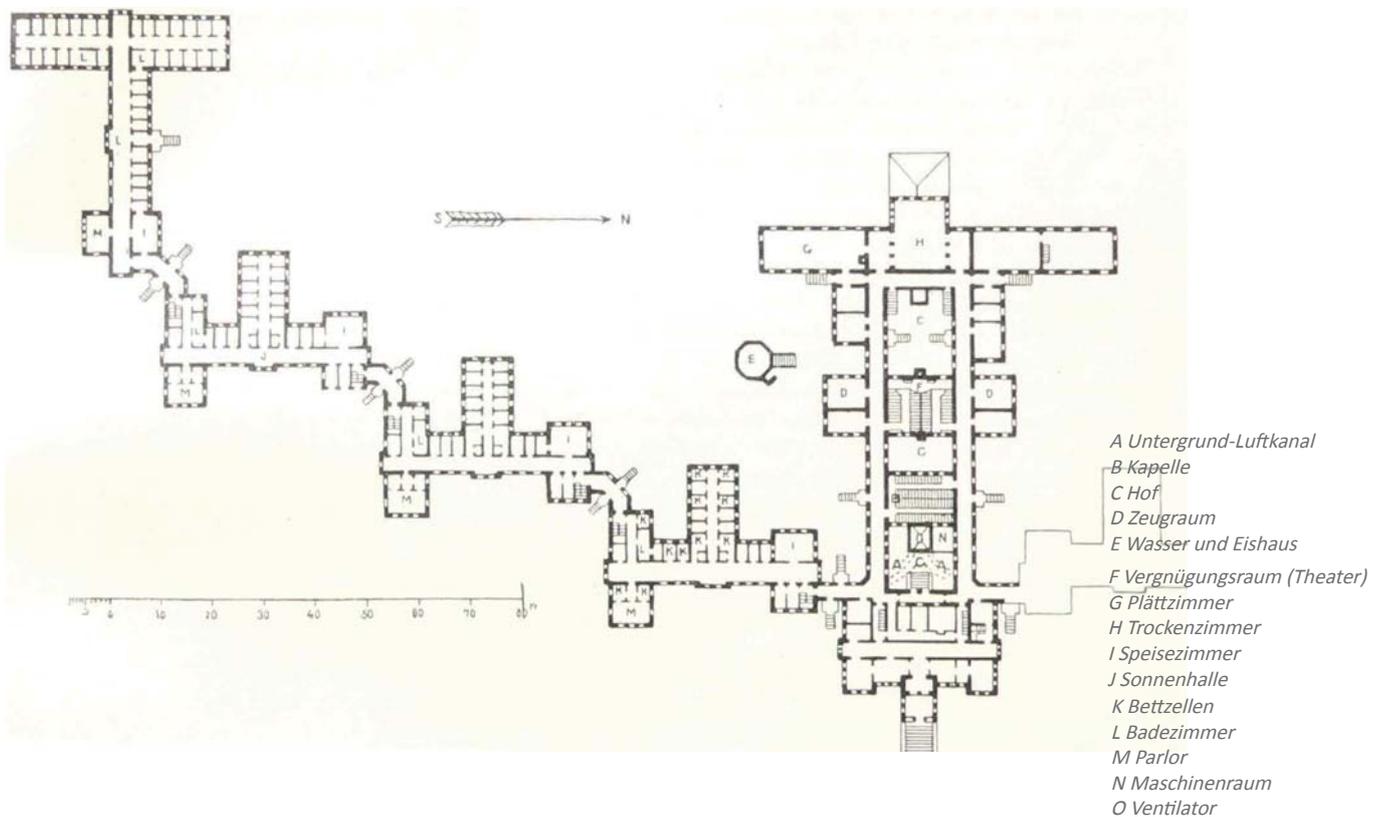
Halber Grundriss des Irrenhauses des Staates Kansas zu Topeka; Deutsche Bauz. 1878, S. 23
